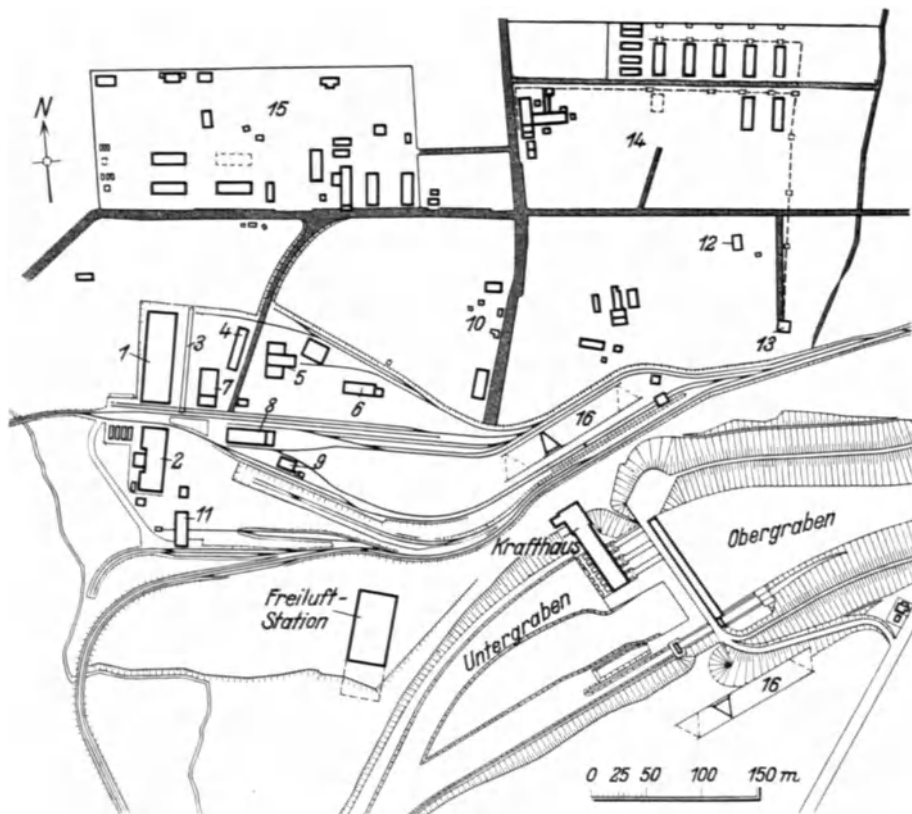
Lageplan der Krafthausbaustelle Irland.
